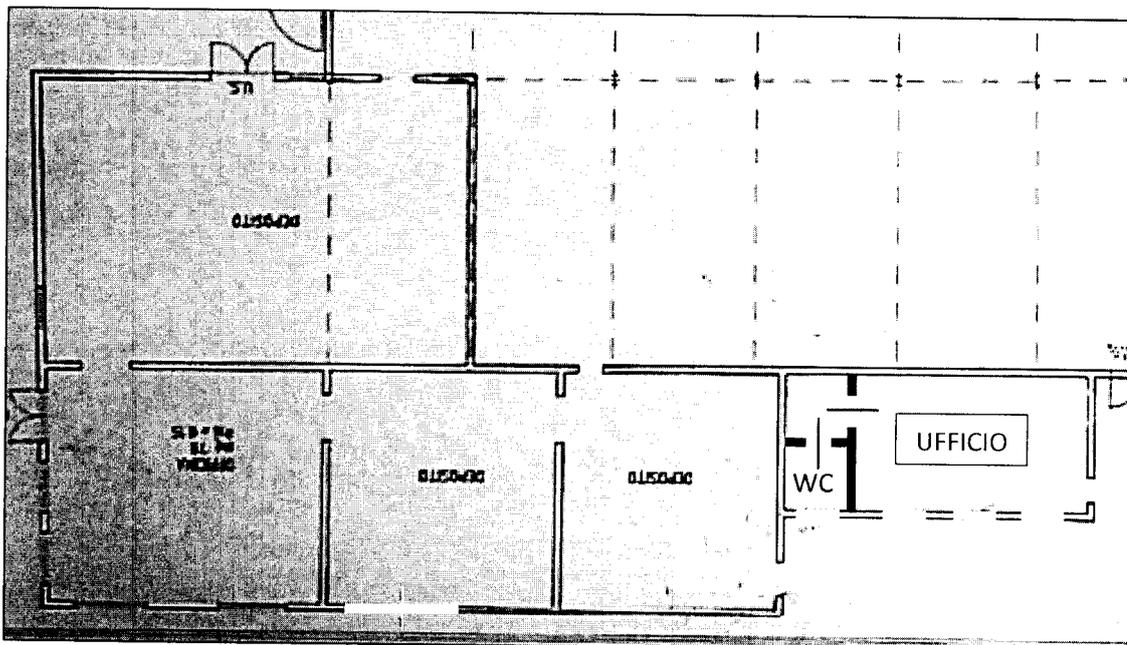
Estratto planimetria C.E. 8.11.1995 – P.T. capannone (porzione destinata a depositi)
